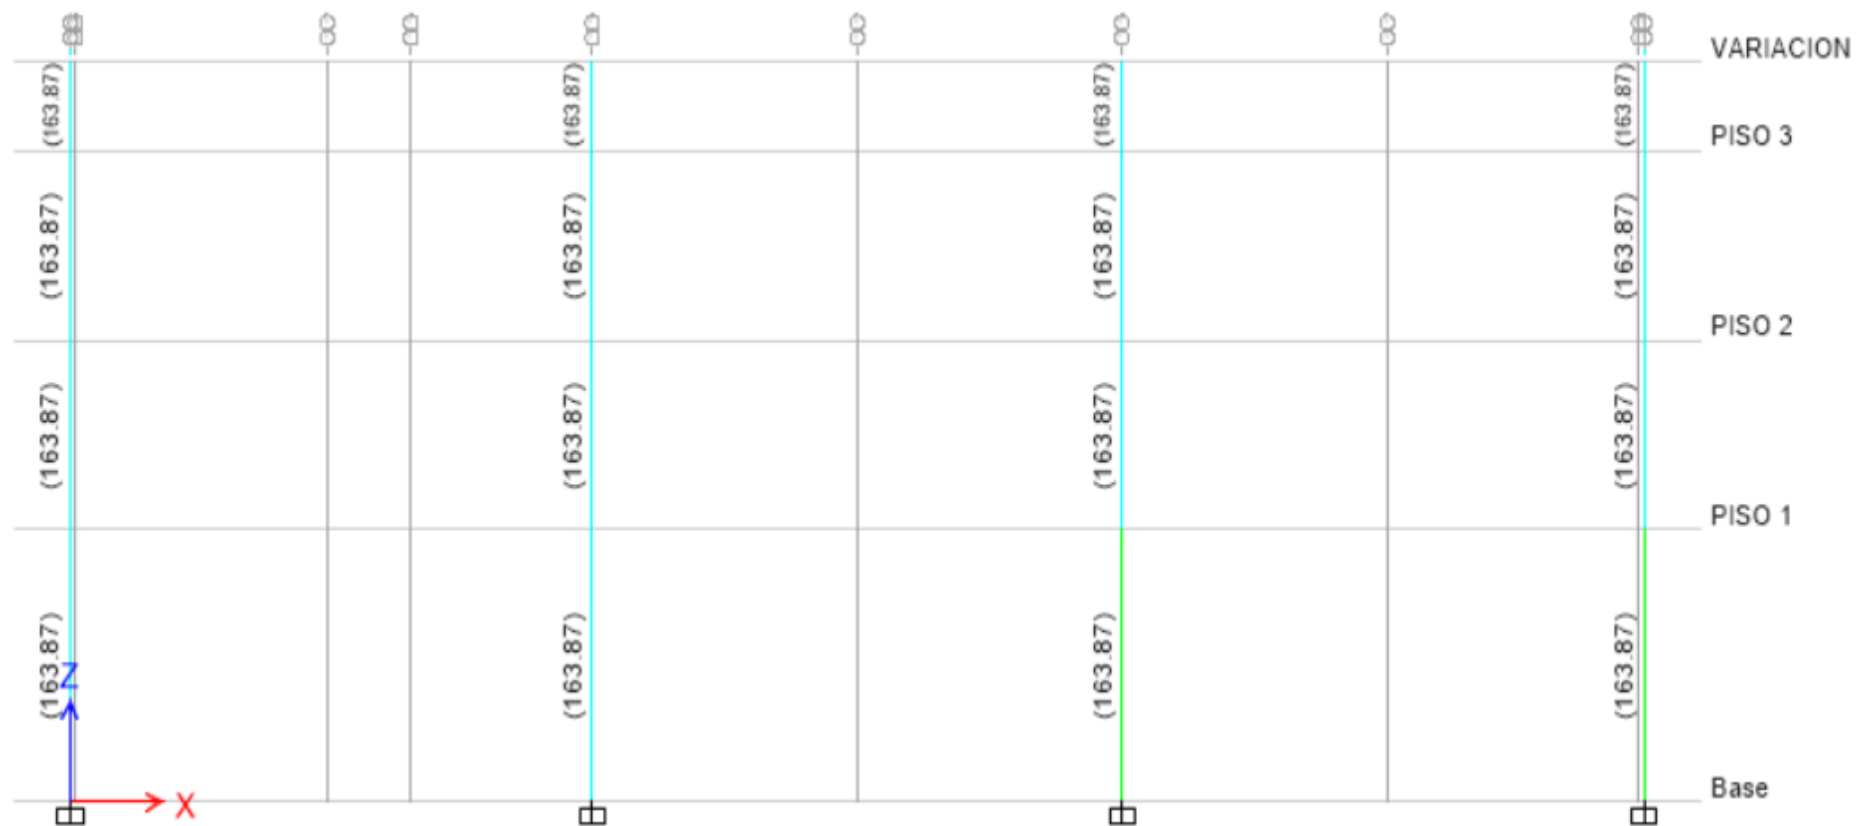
Acero de refuerzo calculado en (cm²) por el programa estructural ETABS para el sistema semi-colgante.
